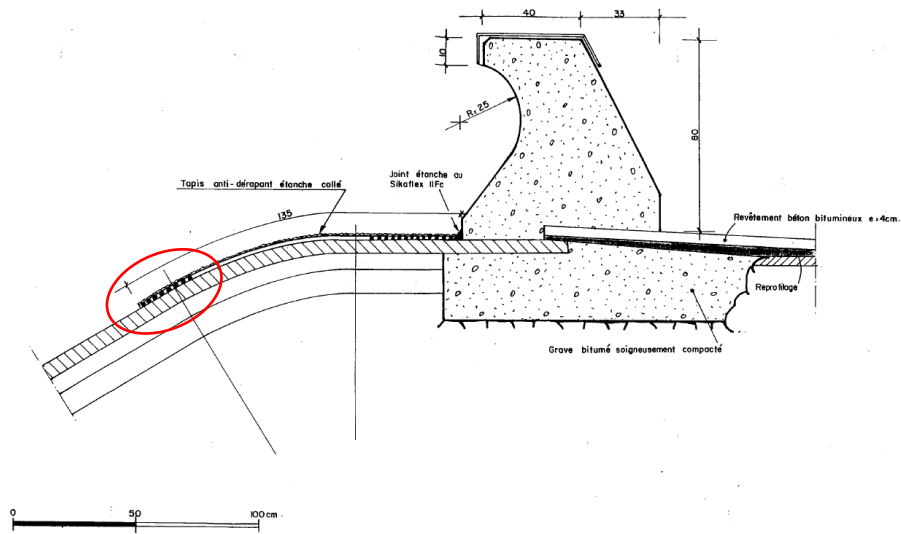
Plan de détail de l'étanchéité au niveau du couronnement
